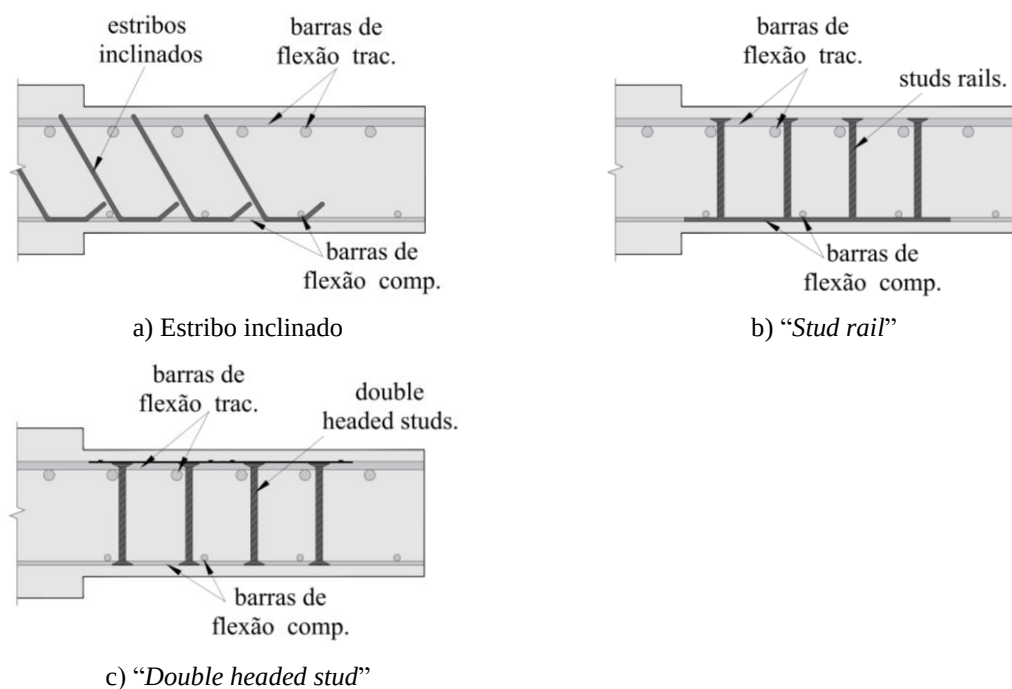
Tipo de armaduras de cisalhamento (continuação) (adaptado de Pereira Filho, 2021).
